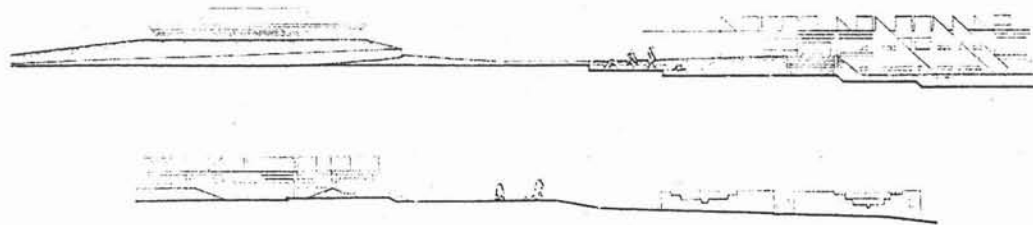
Planta General y Cortes del Centro Cultural Mexiquense
